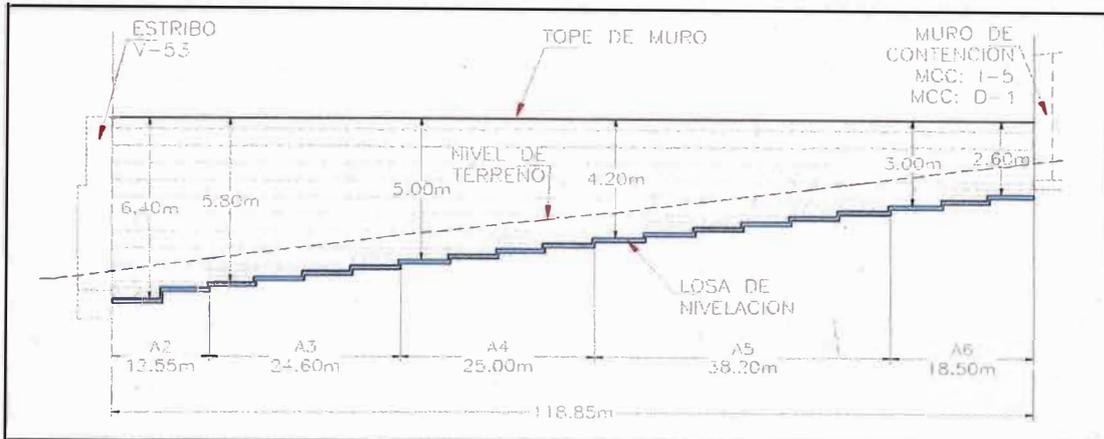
Cola de Vía – Elevación de muro de suelo reforzado.
